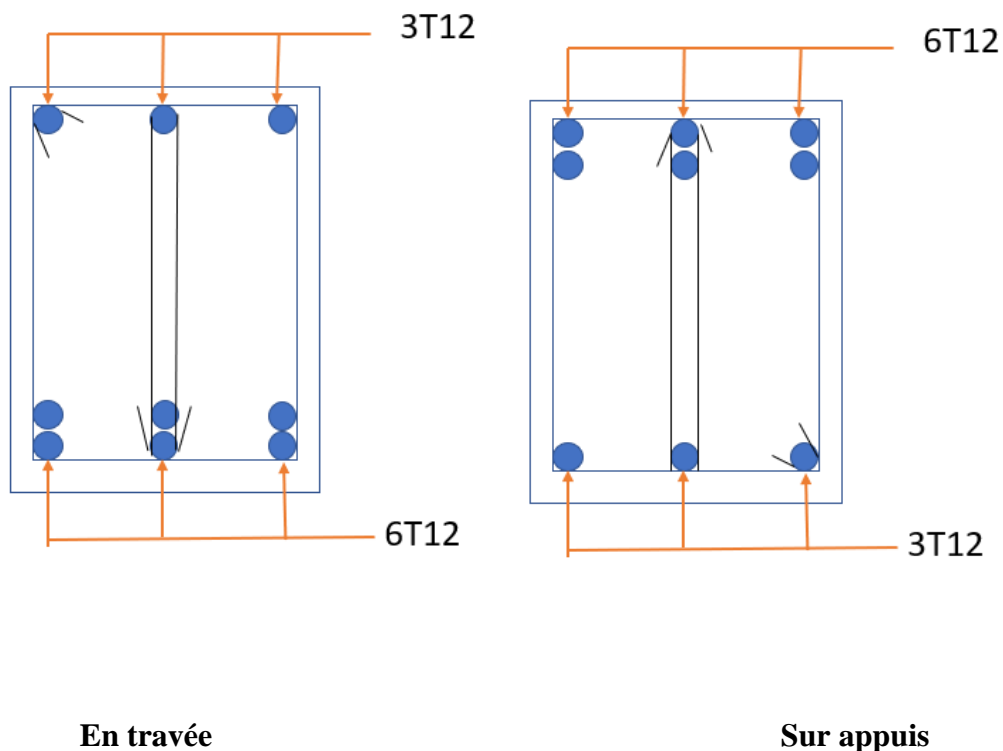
Ferraillage de la poutre non porteuses (30X35)
